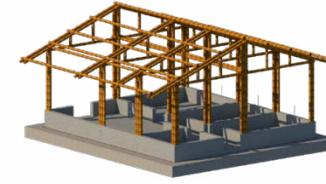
[Figura] Estructura de cubierta Fuente: Autor
